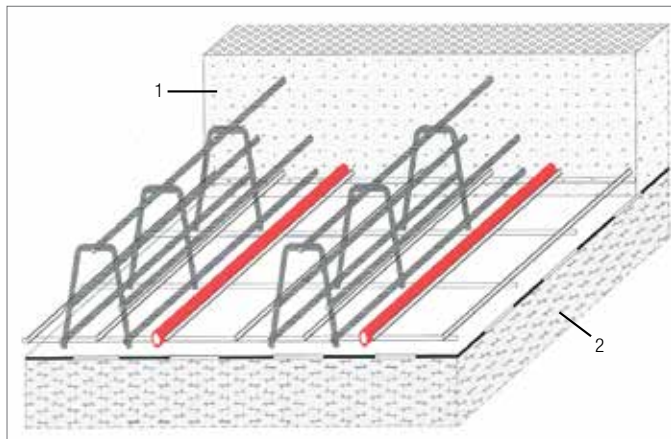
钢架楼板：在下层钢筋架安装加热管的标准施工方式
